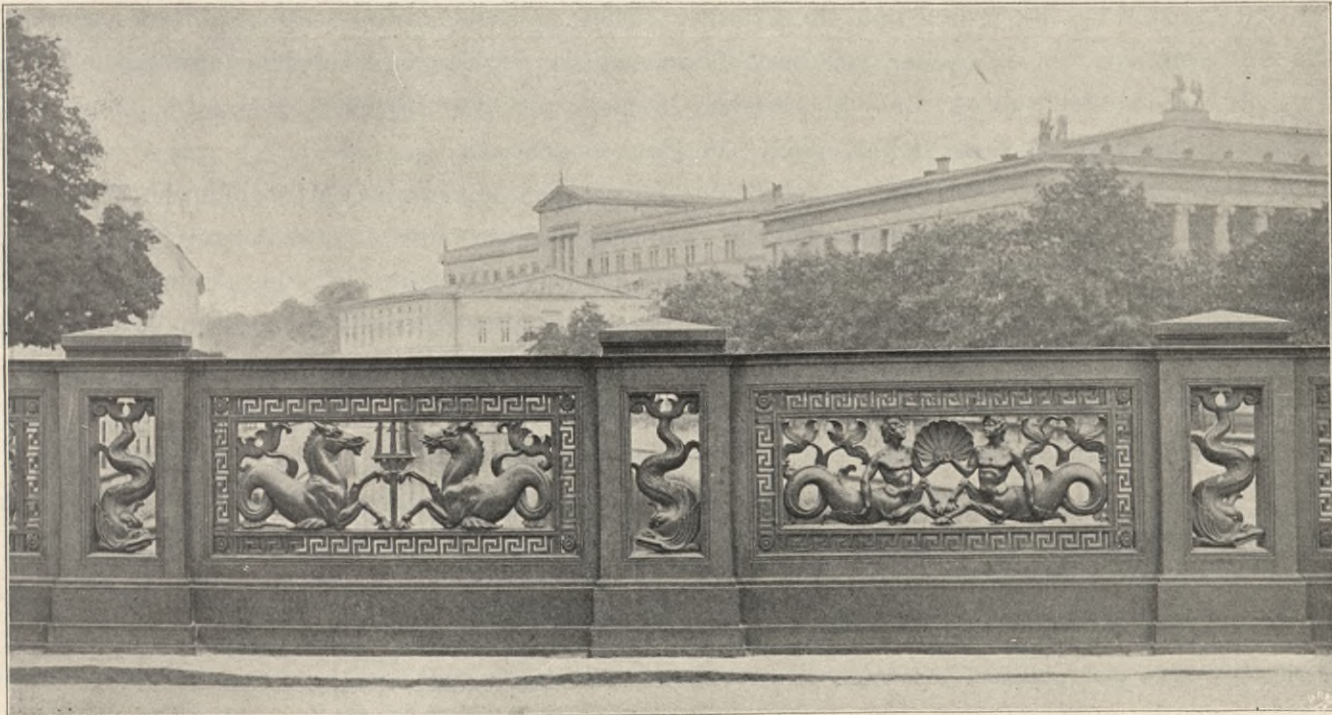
Gusseisernes Geländer der Schloss-Brücke.
